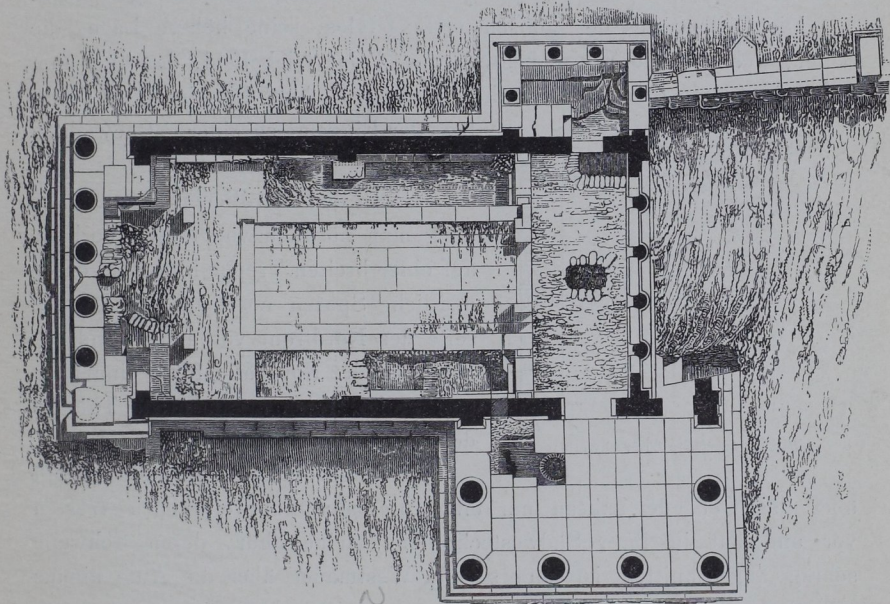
Erechtheion, Grundriss in heutiger Gestalt.
